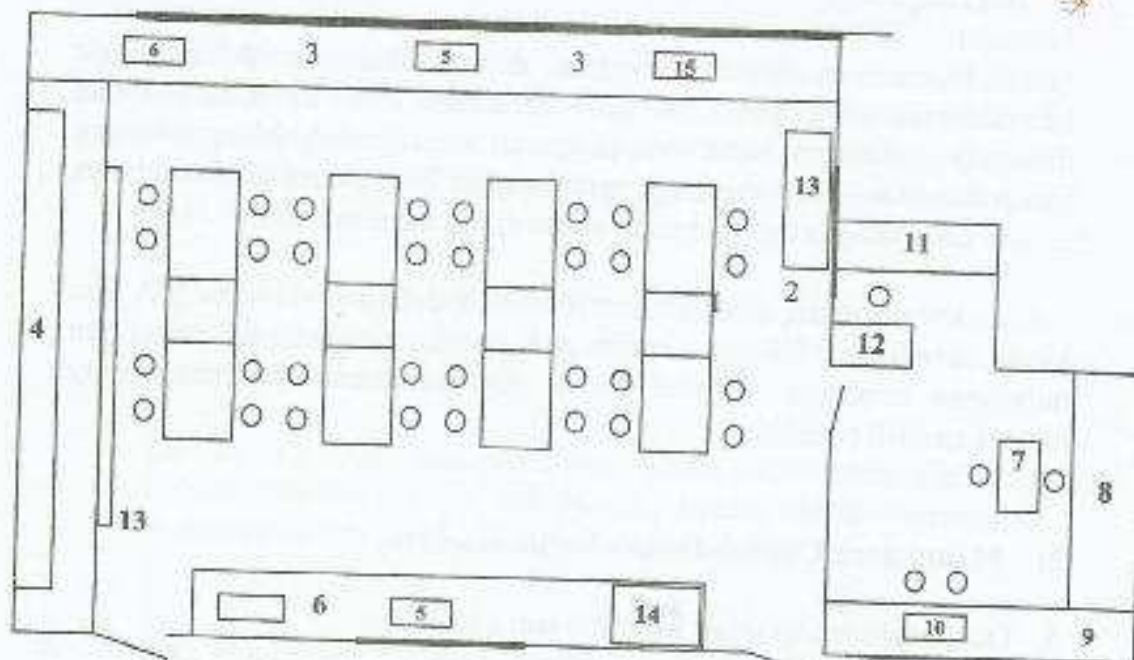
Denah tata ruang tetap laboratorium kimia
